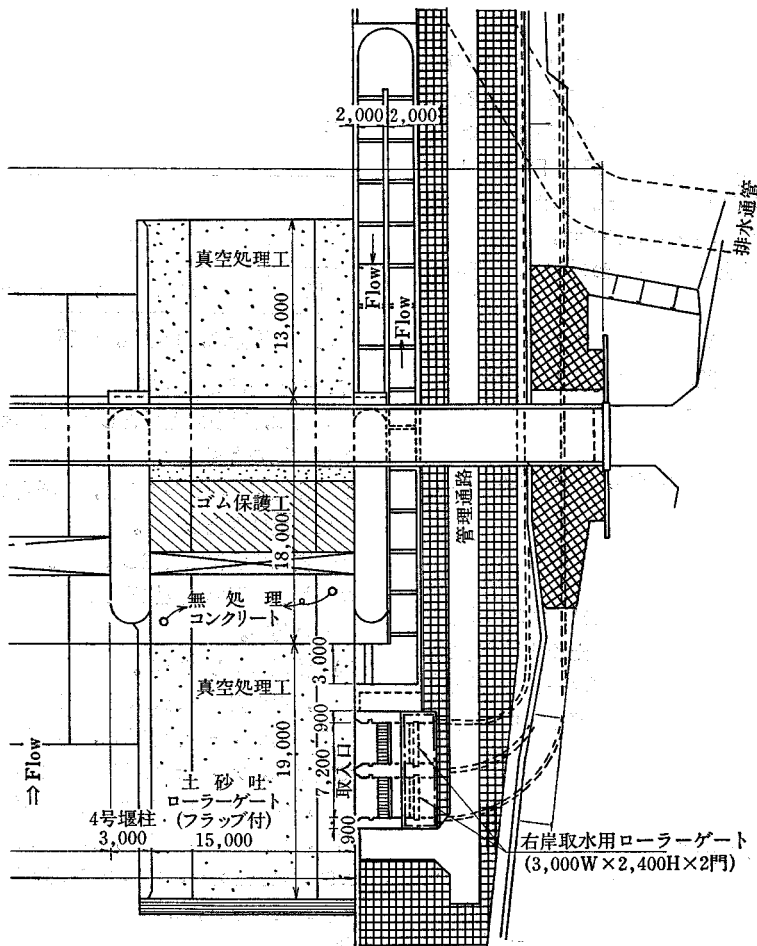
右岸魚道の位置とコンクリート保護工の工法別配置
